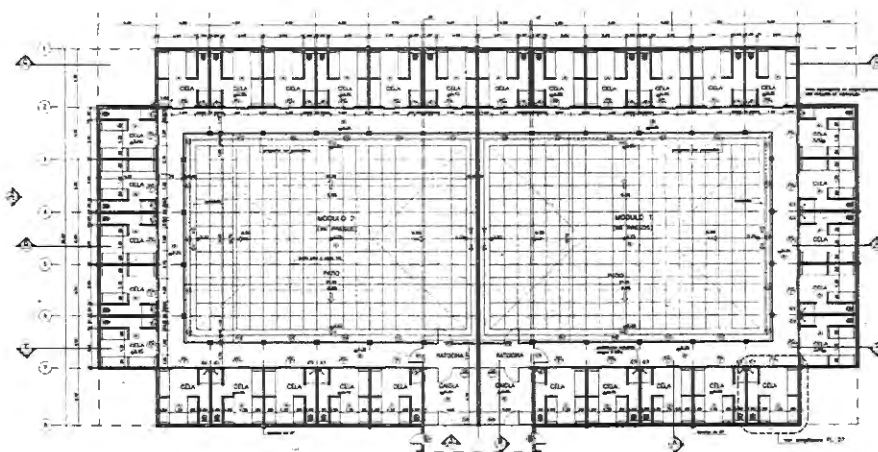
Planta de um módulo da Cadeia de Ribeirão Preto, celas e pátio.
